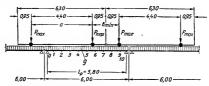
Расчетная схема балки и схема вертикальных изгрузок.
